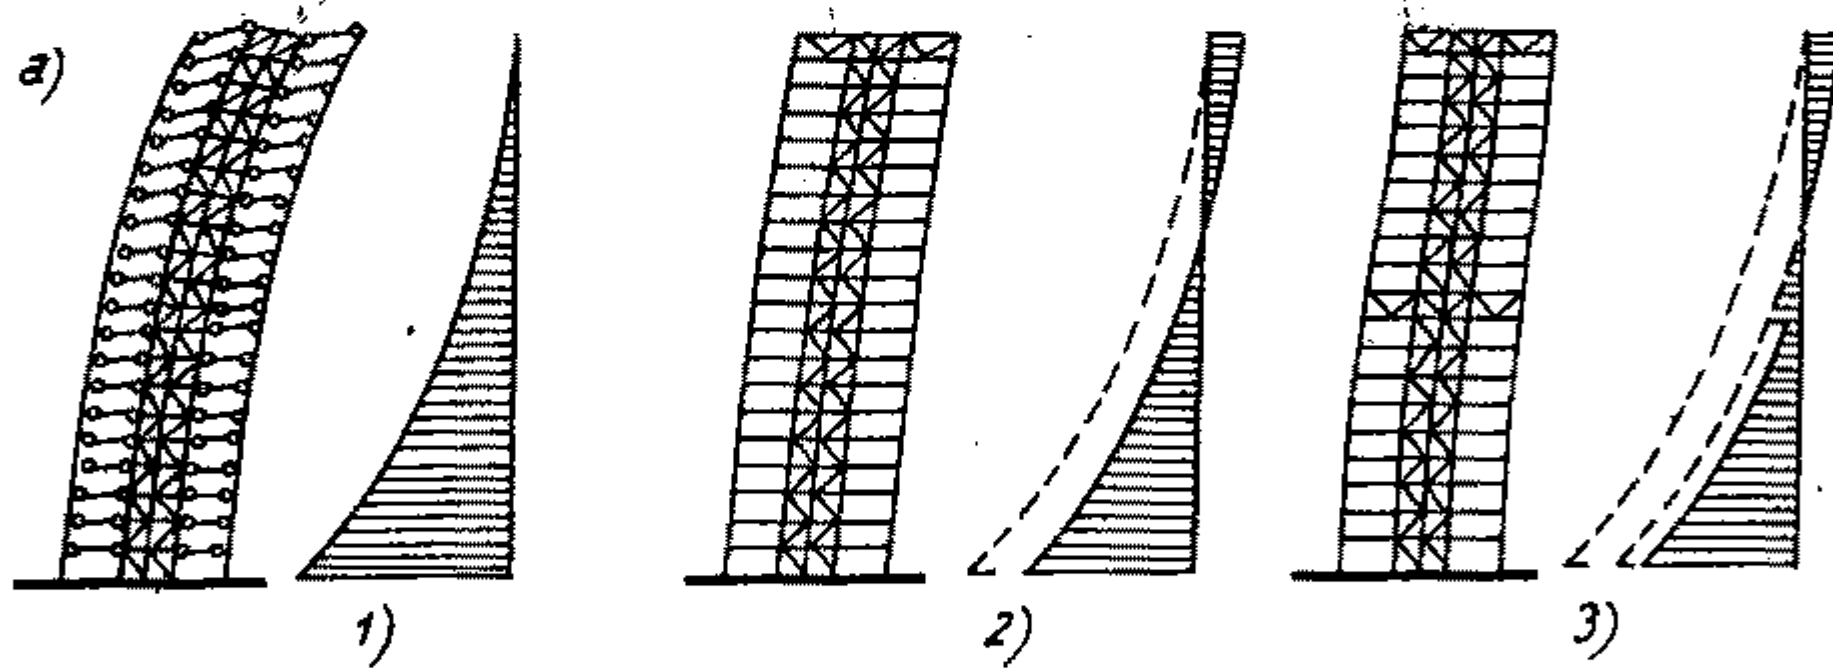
Tổ hợp kết cấu chịu lực của sơ đồ khung giằng
